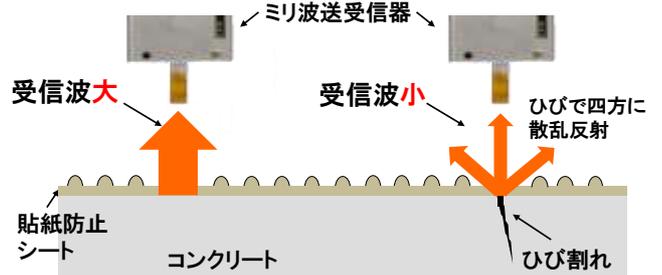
ひび割れ可視化の原理 (左)表面反射, (右)ひび割れ散乱
